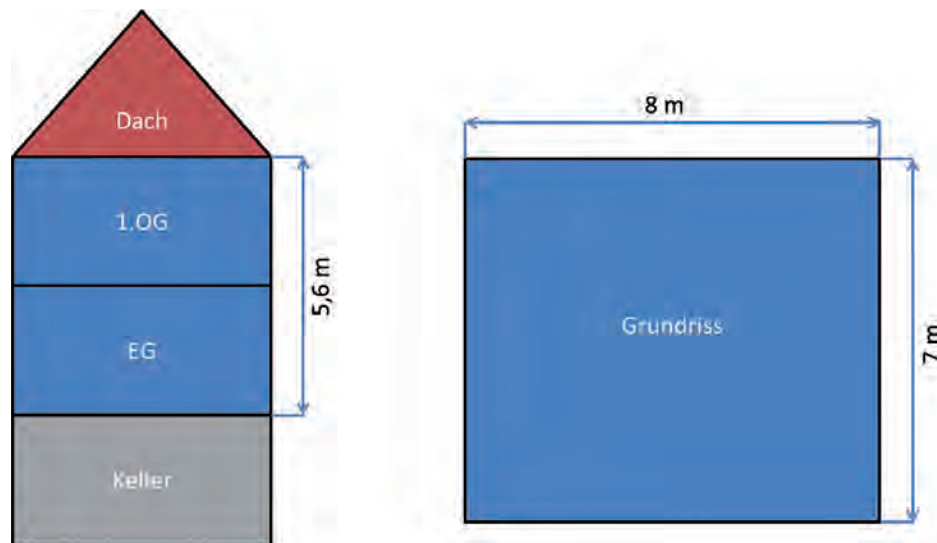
Grundriss und Schnitt des betrachteten Gebäudes
